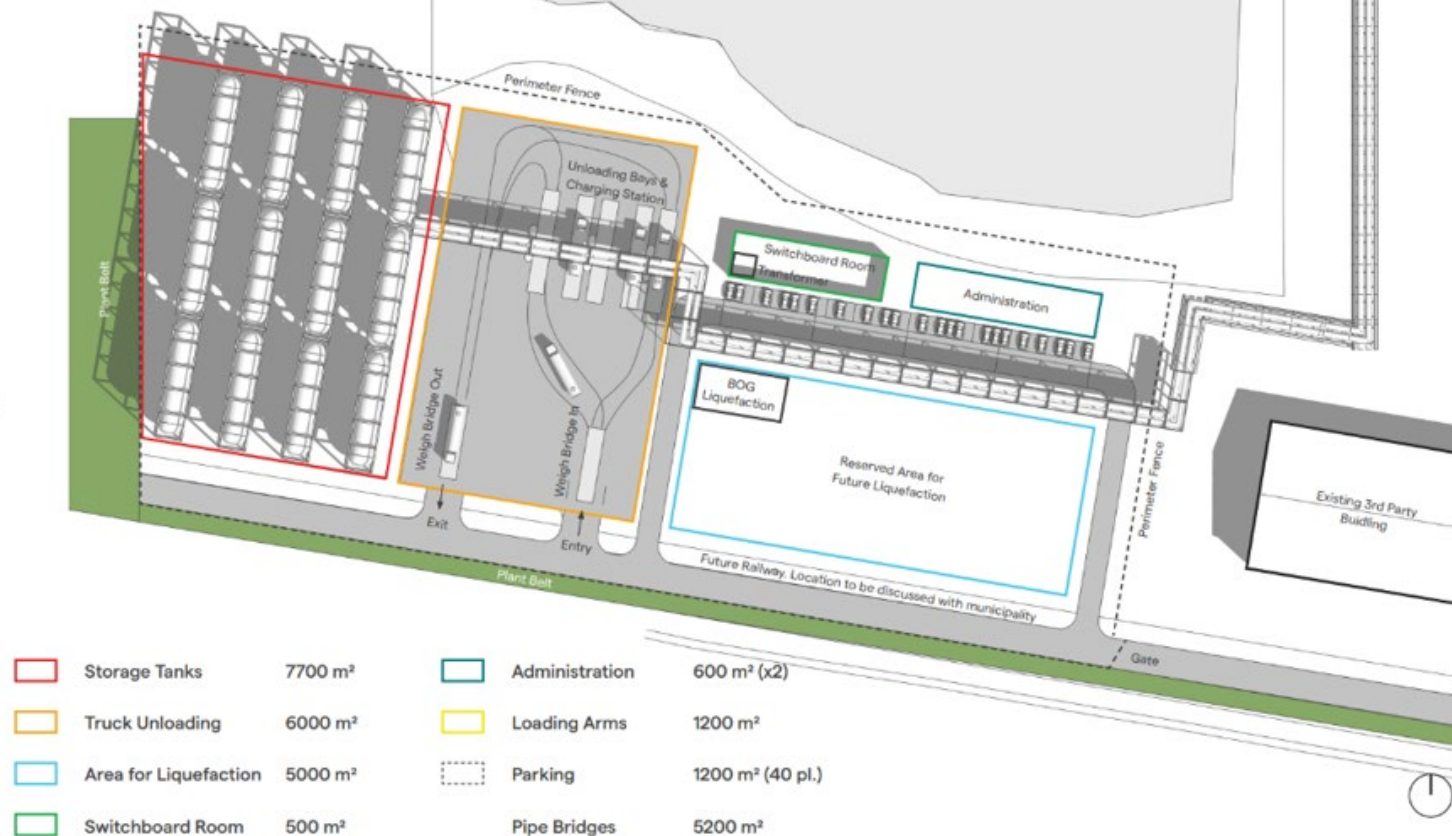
Skitse over projekt-og anlægsområde. Obs – den hvide bygning yderst til højre i billedet indgår ikke i CO₂ terminal-projektet. Placering og udformning er ikke endeligt og layout kan ændres som følge af detailprojektering.
